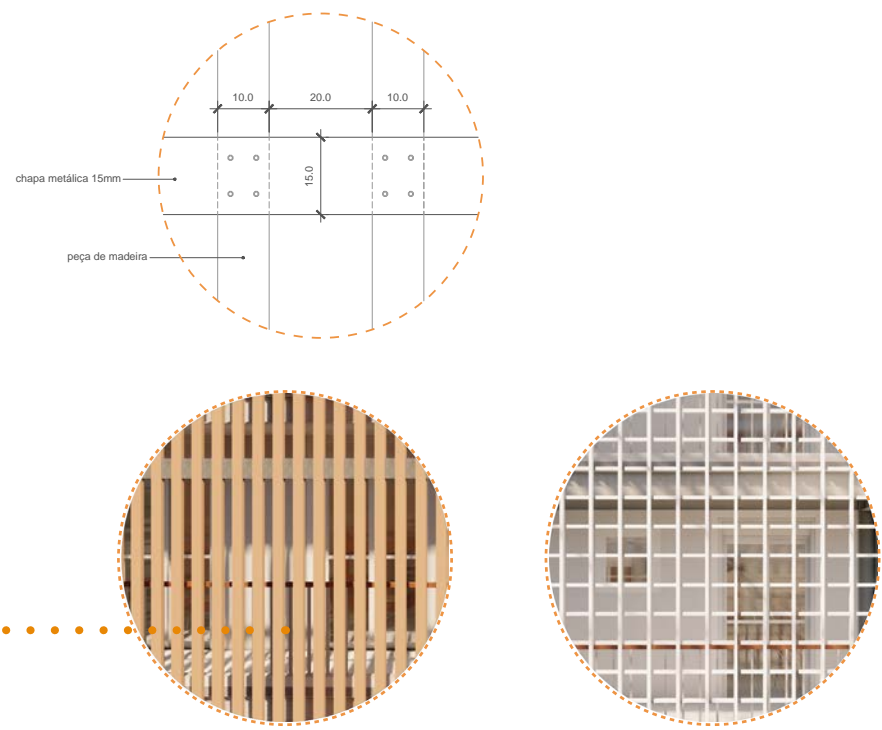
Detalhe construtivo de fixação dos brises de madeira, vista frontal.
